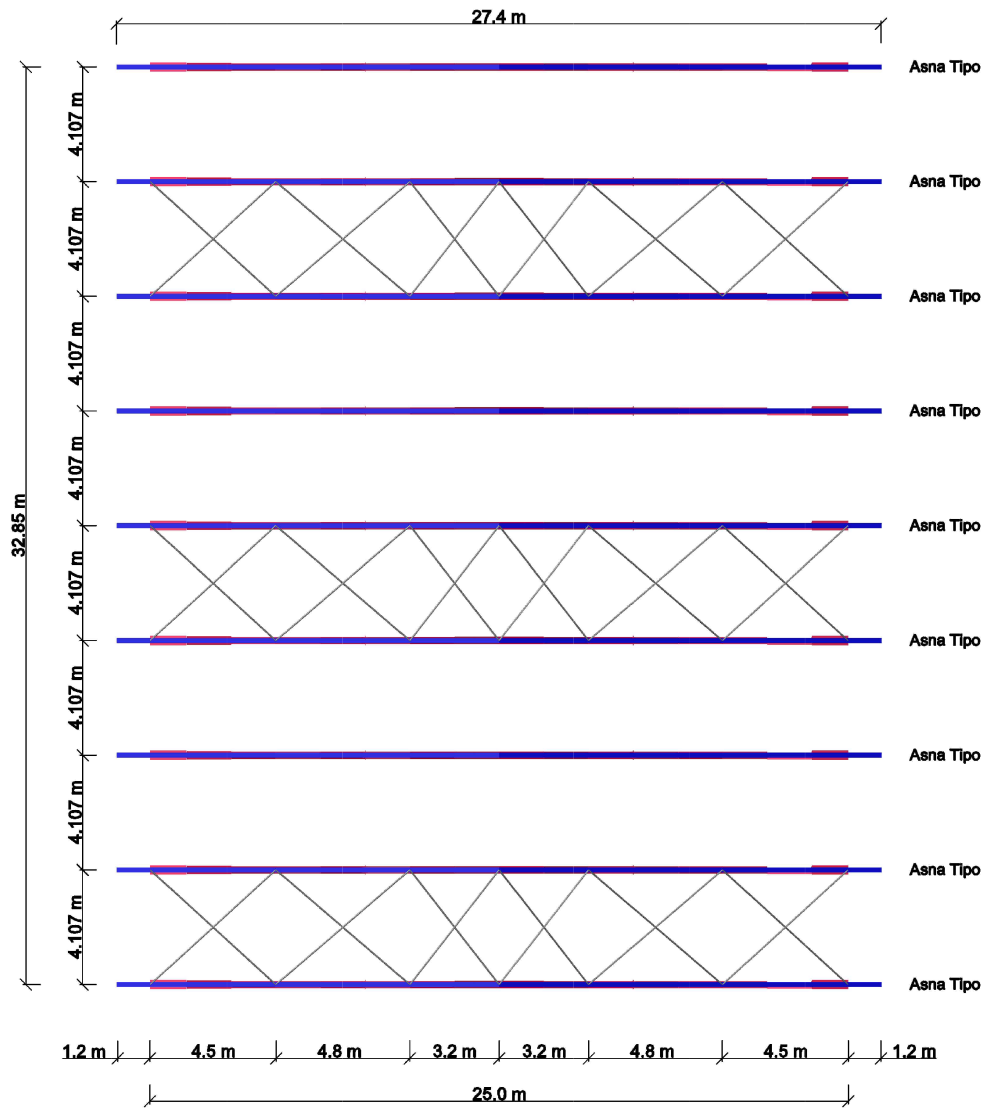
Planta de travamentos ao nível das águas da cobertura - Módulo tipo.
